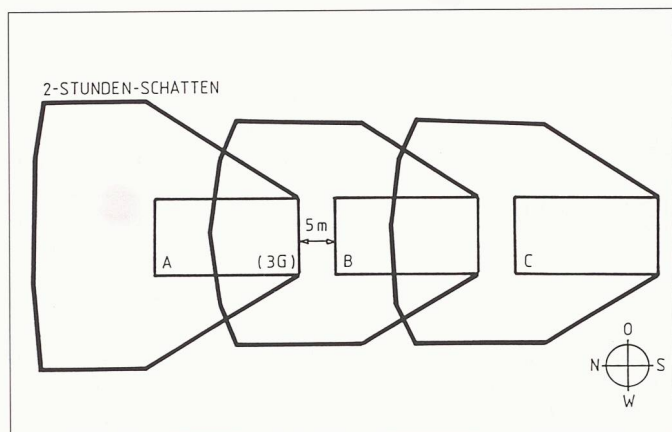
Typische Ost-West-Bebauung in Reihe. Gebäude C beschattet jedoch Gebäude B und Gebäude B Gebäude A mehr als 2 Stunden. Die Fassaden werden jedoch trotzdem gut besonnt. (Aus einem Siedlungsentwurf für Lenzburg.)
